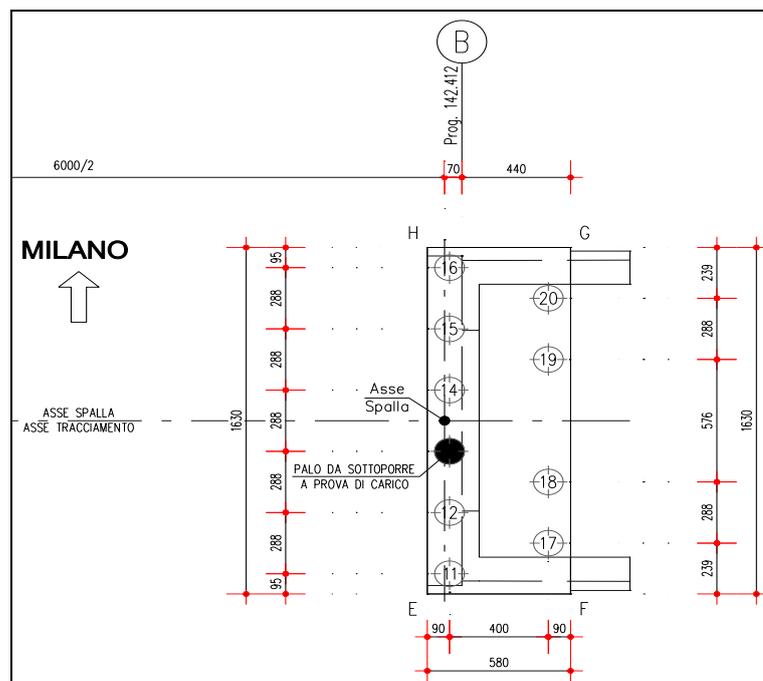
Spalla B - Schema posizione palo di prova
